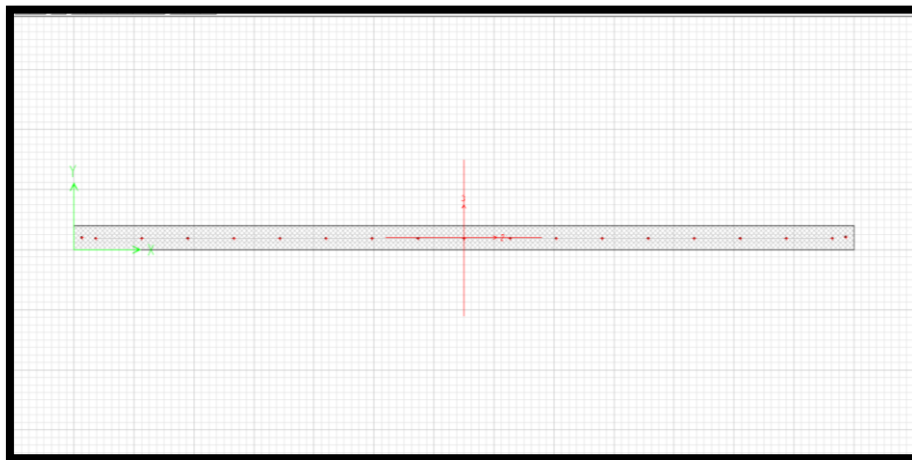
DISTRIBUCIÓN DE BARRAS DE ACERO EN MURO DELGADO
